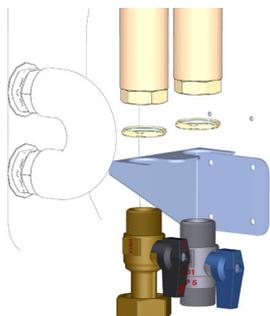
Detail Blockierung der Rohrleitungen an der unteren Halterung
